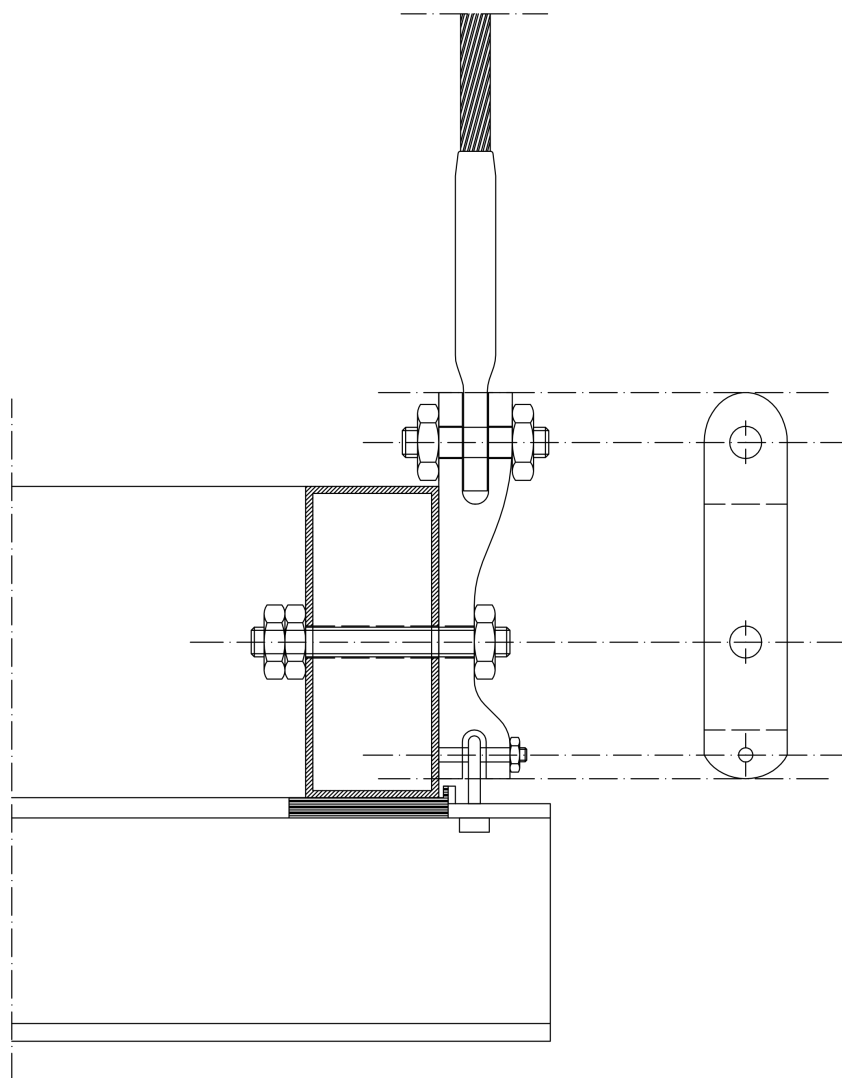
Detalhe construtivo da ligação pendural – viga temporária – tabuleiro, corte transversal do tabuleiro
